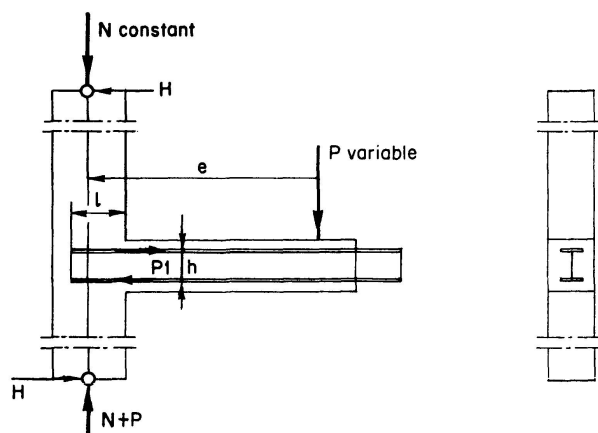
Schema de l'essai d'un nœud à 3 branches.
